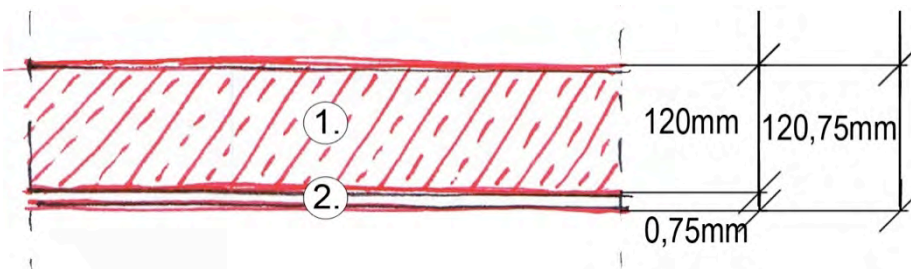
Durchschnittliche Betonmenge, = 120mm Beton Bestand und Blech 0,75mm _ Decke Trapezblech 14cm
